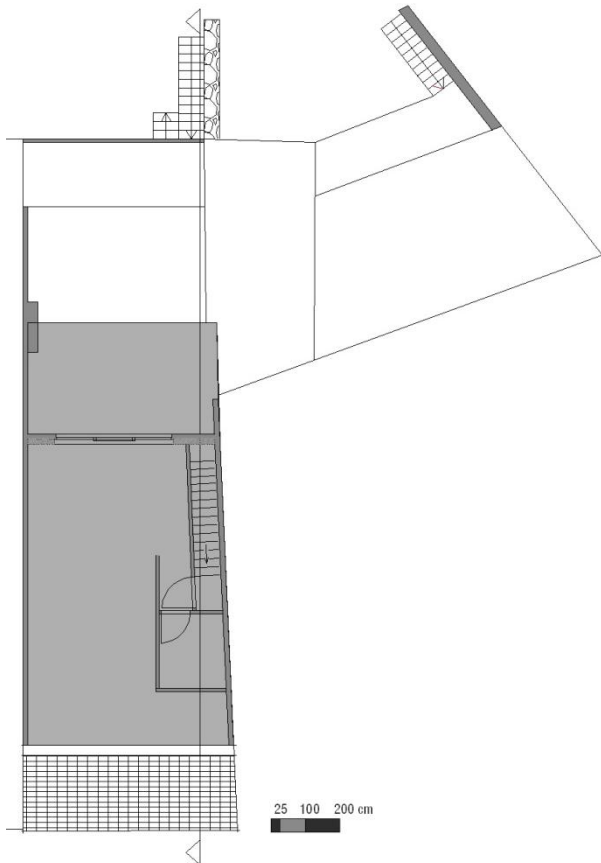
Plan du 5° étage (Source : Draps E., 2010)
